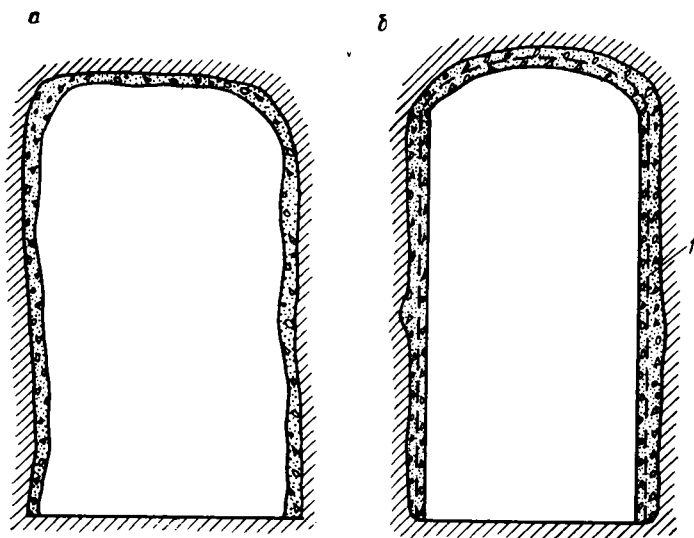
Конструкция набрызг-бетонной крепи:
